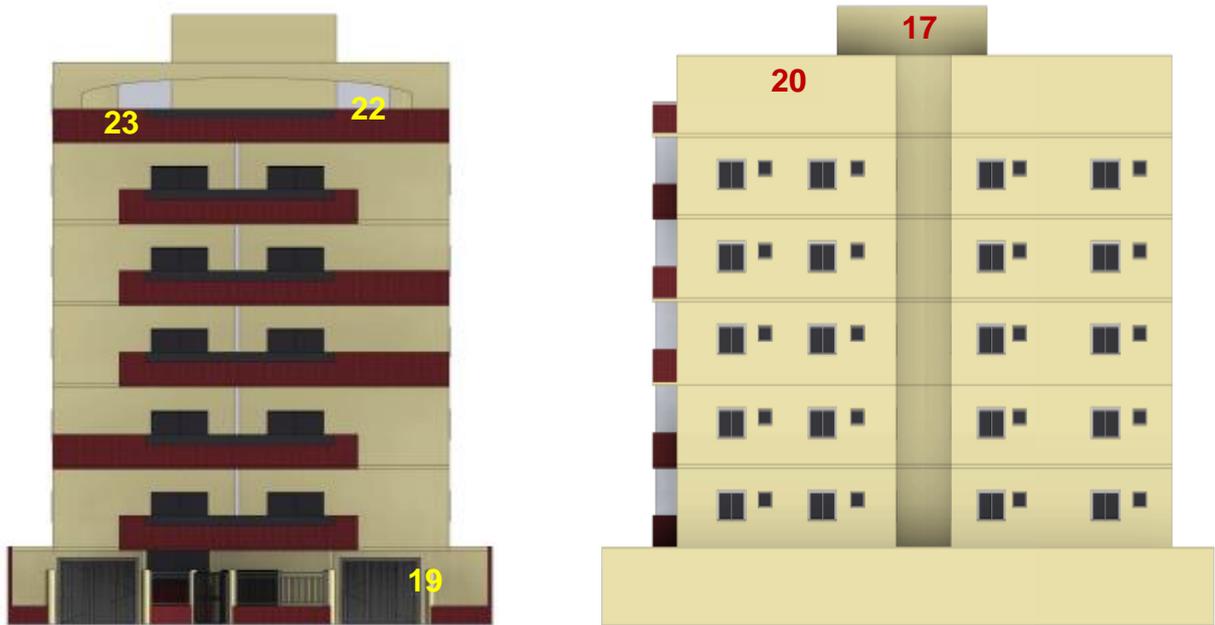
Fachadas do fundo e lateral esquerdo da edificação
